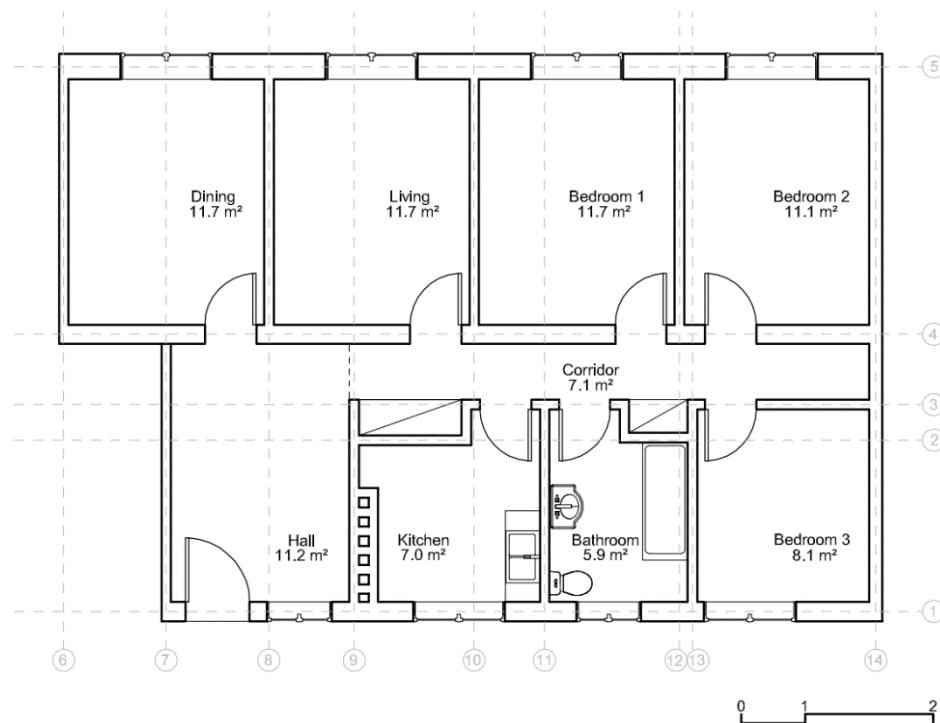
Planta baixa Casa de Las Flores no Revit.
